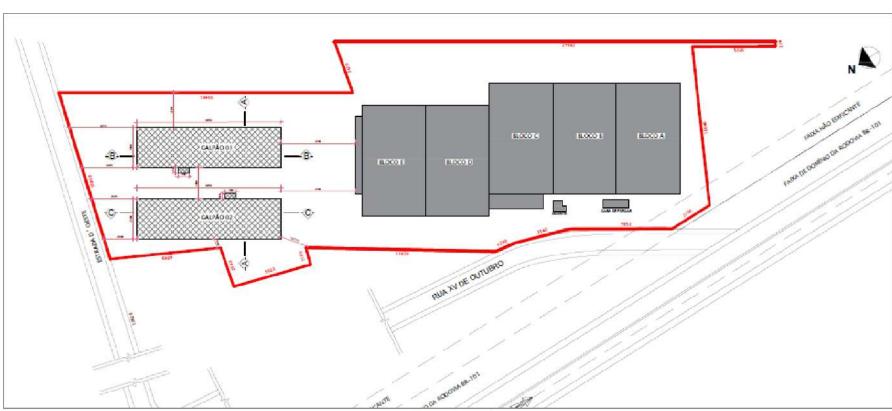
Planta de implantação. Fonte: Arquivo pessoal, 2021.
